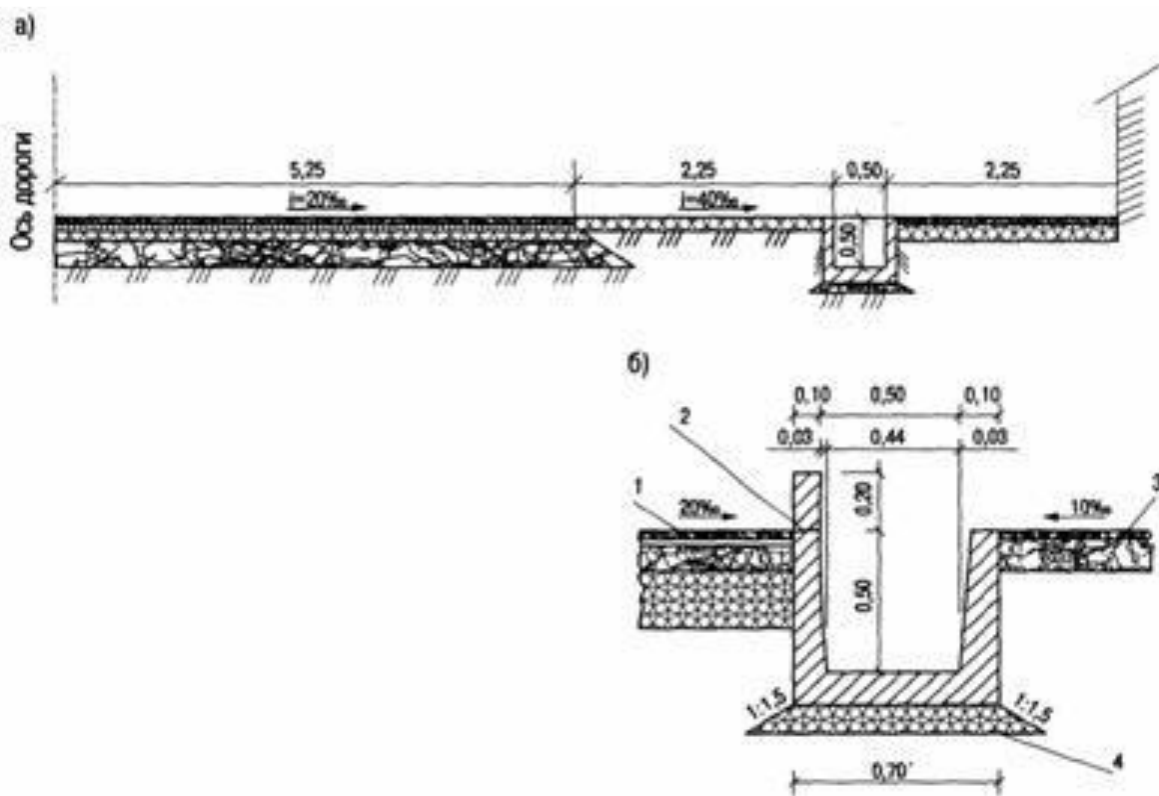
Система организации поверхностного водоотвода на автомобильной дороге Кундуз – Файзабад (Афганистан) с водосбросными лотками: а - прямоугольного поперечного сечения; б – трапецидального поперечного сечения; 1 - проезжая часть; 2 - прорези по 20 см через 1 м; 3 - тротуар; 4 - основание из гравийного материала
